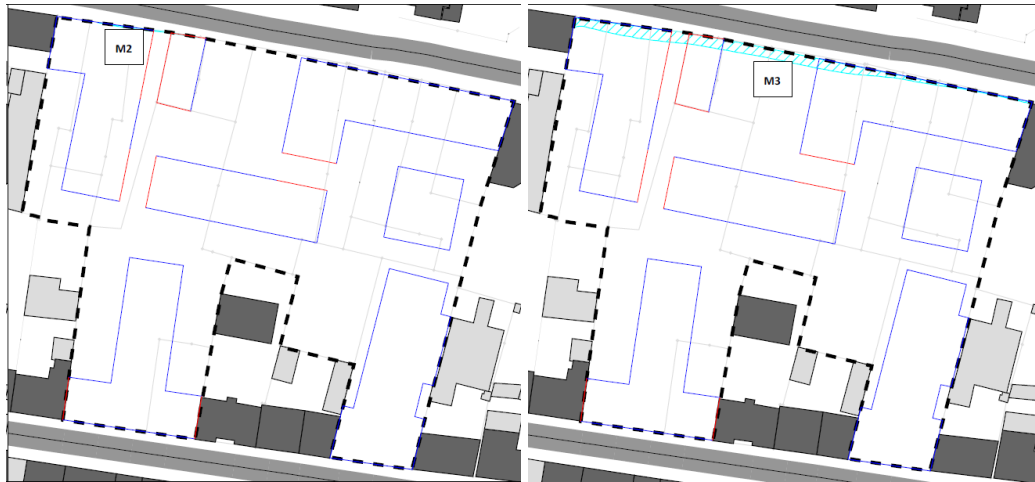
Schallschutzmaßnahme M2 (Grundrissorientierung Tag) und M3 (Grundrissorientierung Nacht) (genordet, ohne Maßstab)
